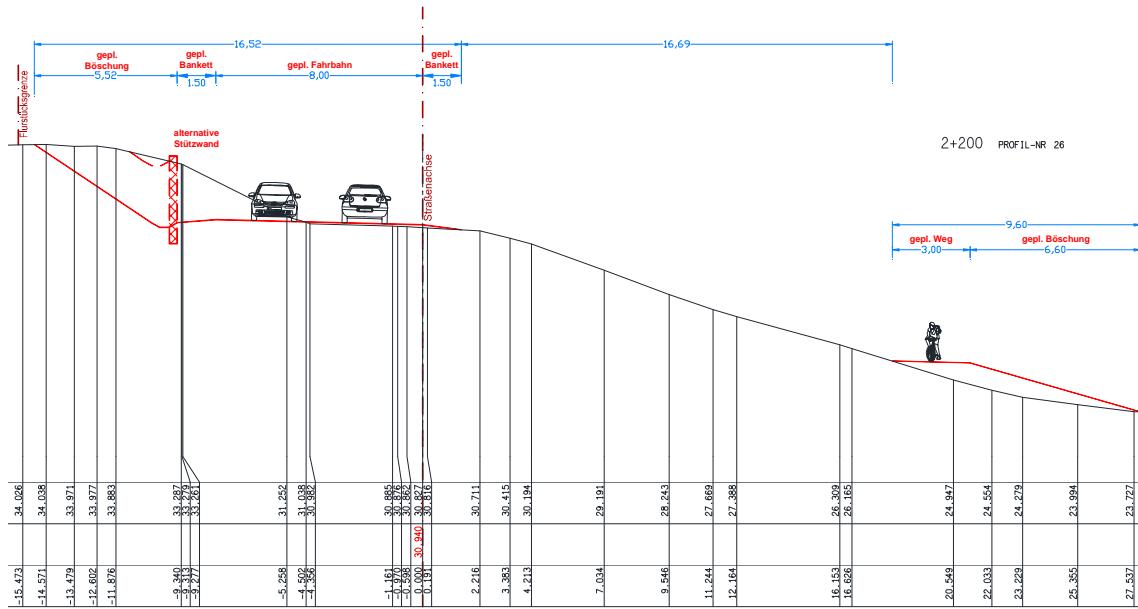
Abschnitt 6, Vorzugsvariante Trasse T1
